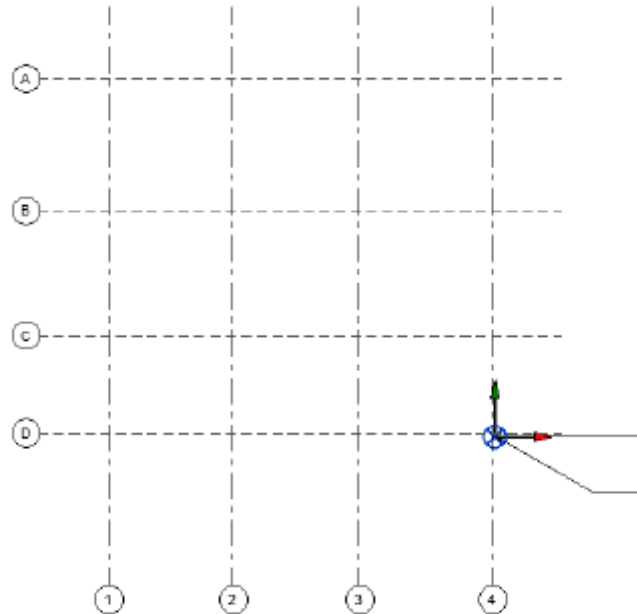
Plantilla de ejes del modelo Arquitectónico.
